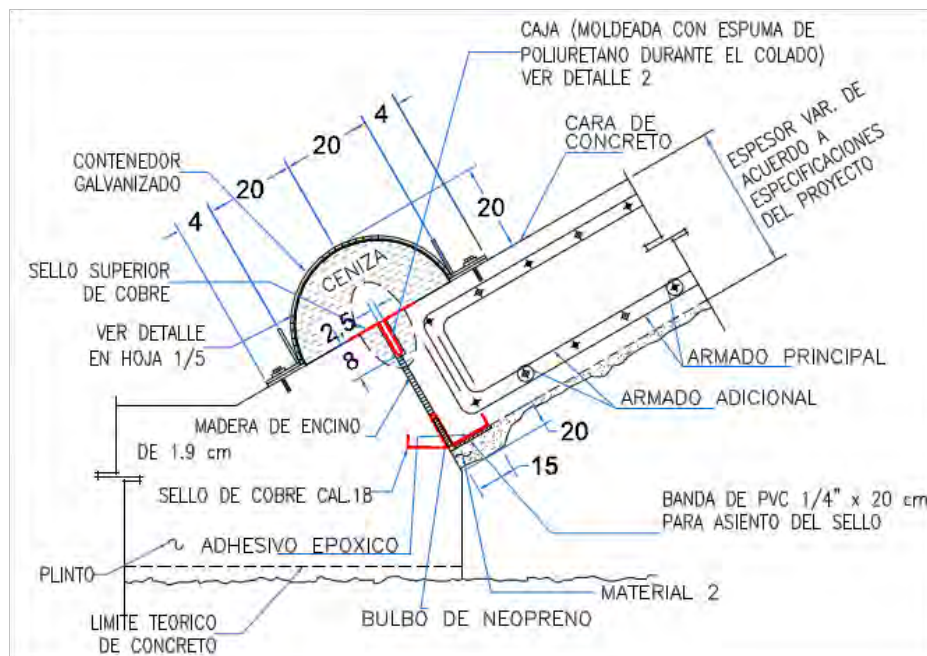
Detalle de la junta perimetral (Tipo 1)
